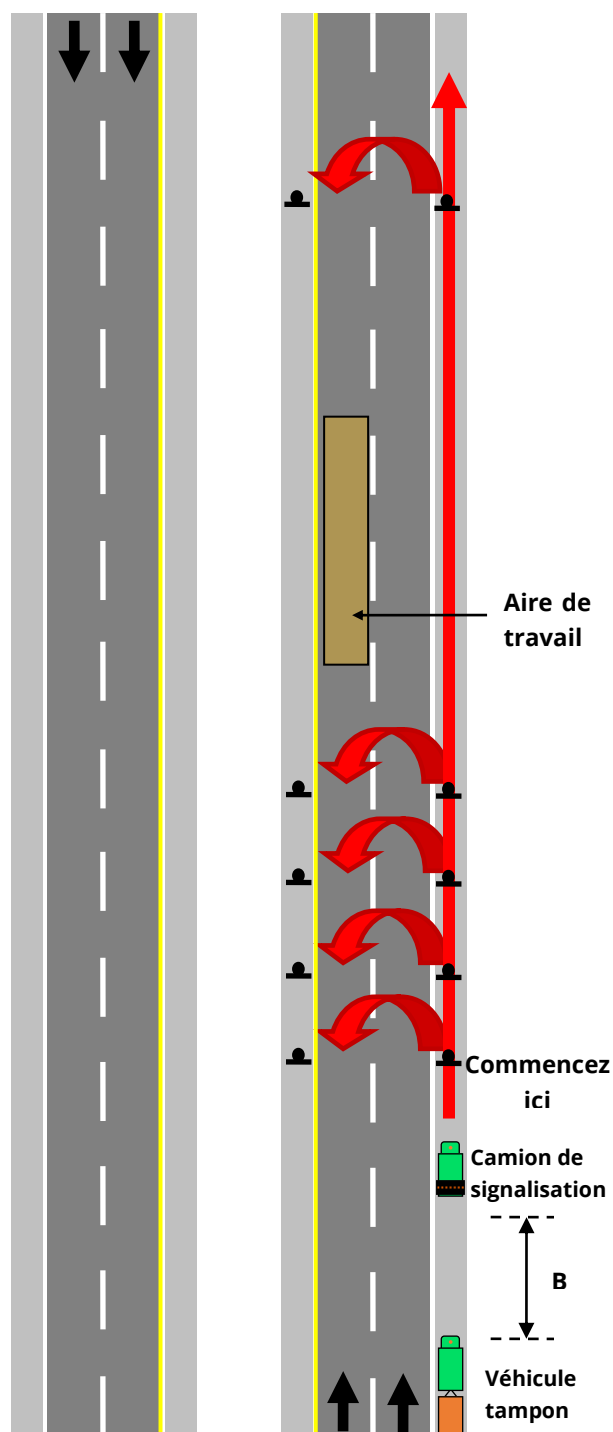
Installation des panneaux (routes à voies multiples à chaussées séparées)
